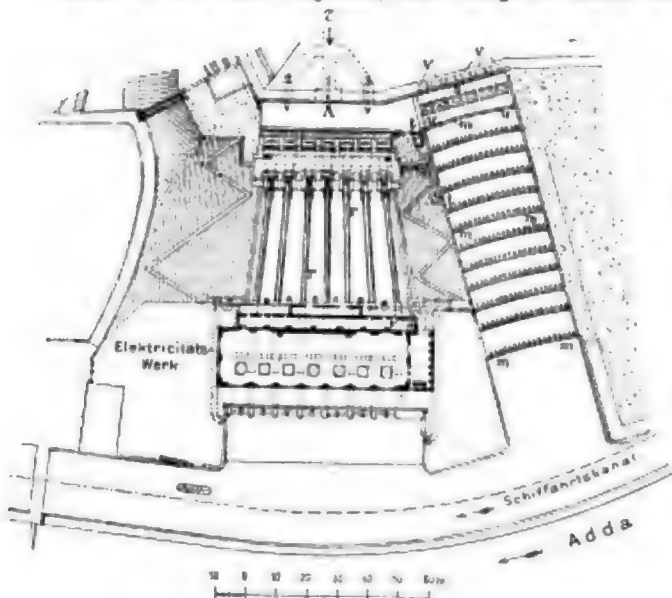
Detail-Lageplan des Electricitätswerkes.
